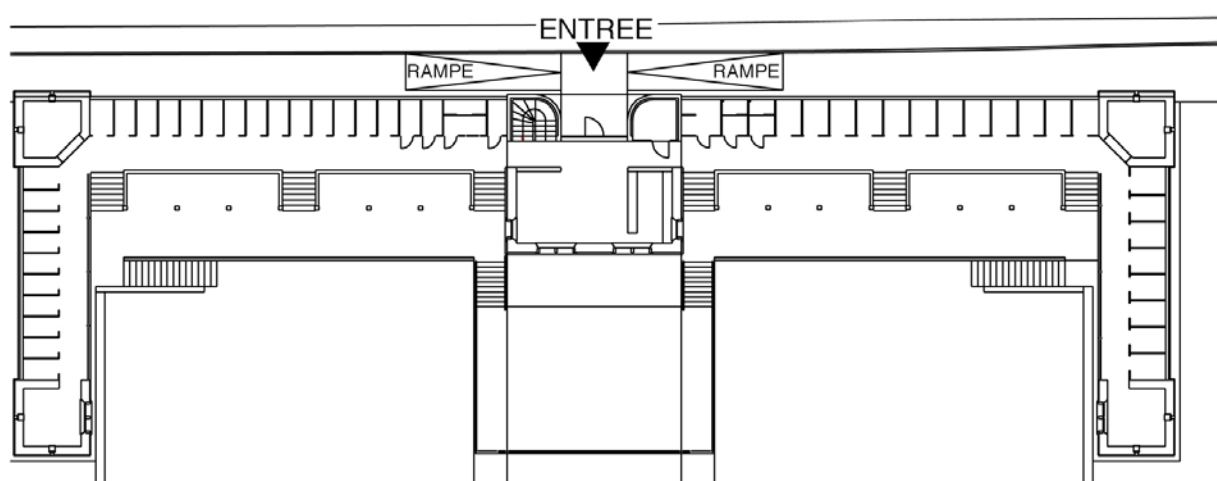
Plan du rez-de-chaussée des Bains des Dames
